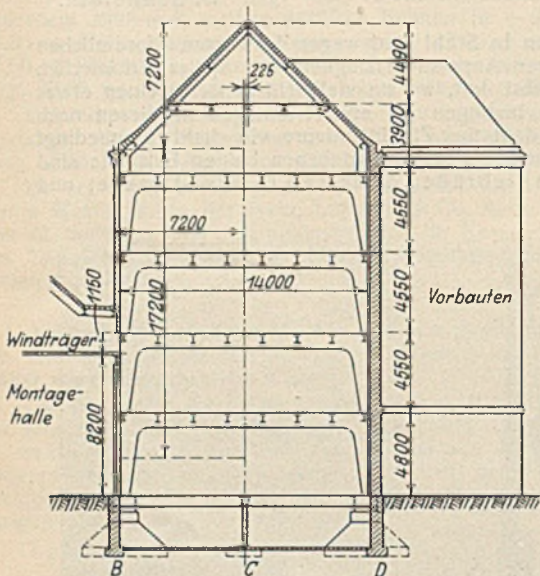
Fabrikgebäude in Kiel. Querschnitt.
